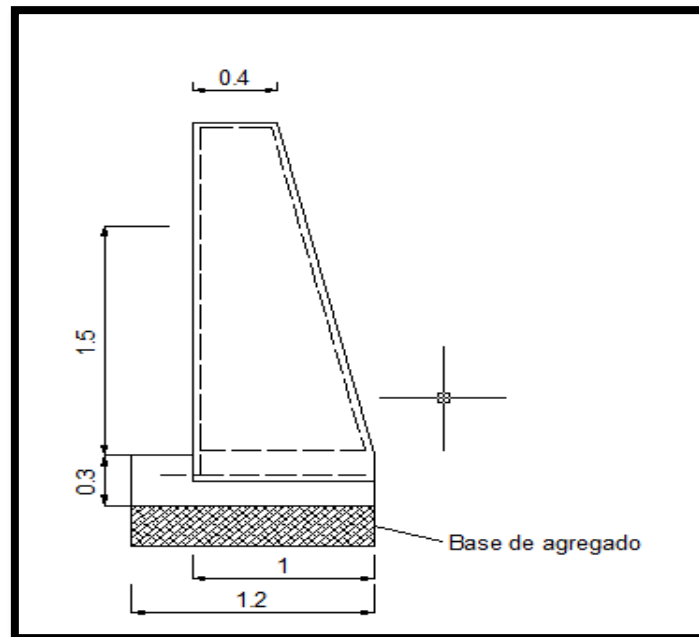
Elevación lateral de cabezal para alcantarillas de 1600mm.
